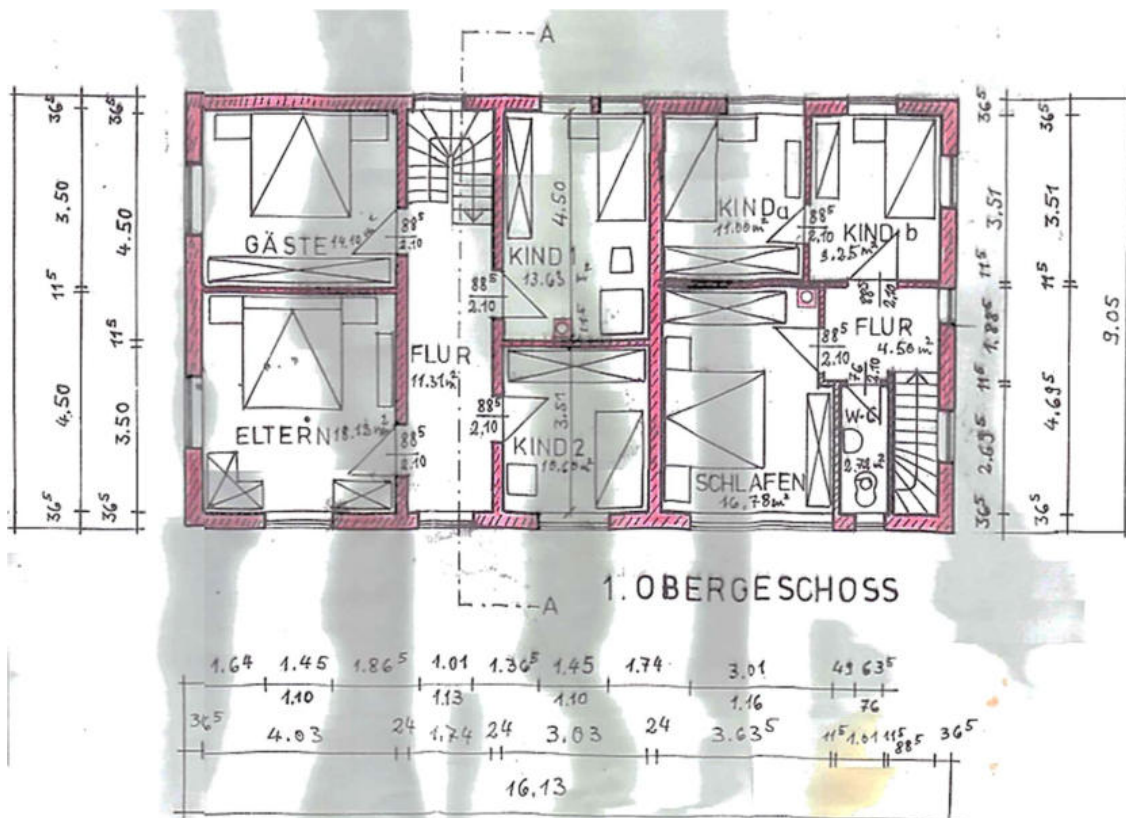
Grundriss 1. Obergeschoss (Aufstockung 1997)
